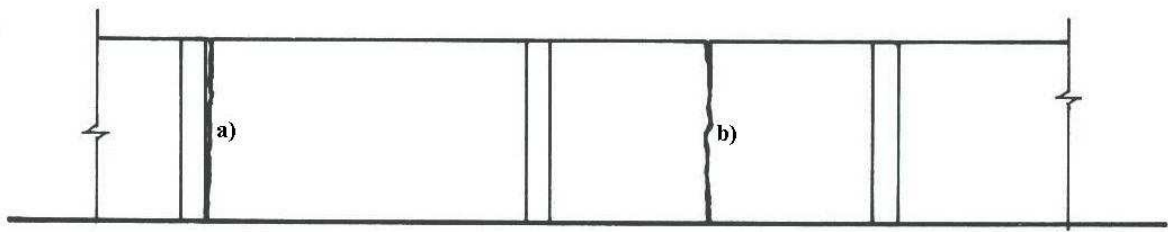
Fissuras verticais (a) entre alvenaria e pilar; (b) no corpo da alvenaria (Thomaz, 1989).
